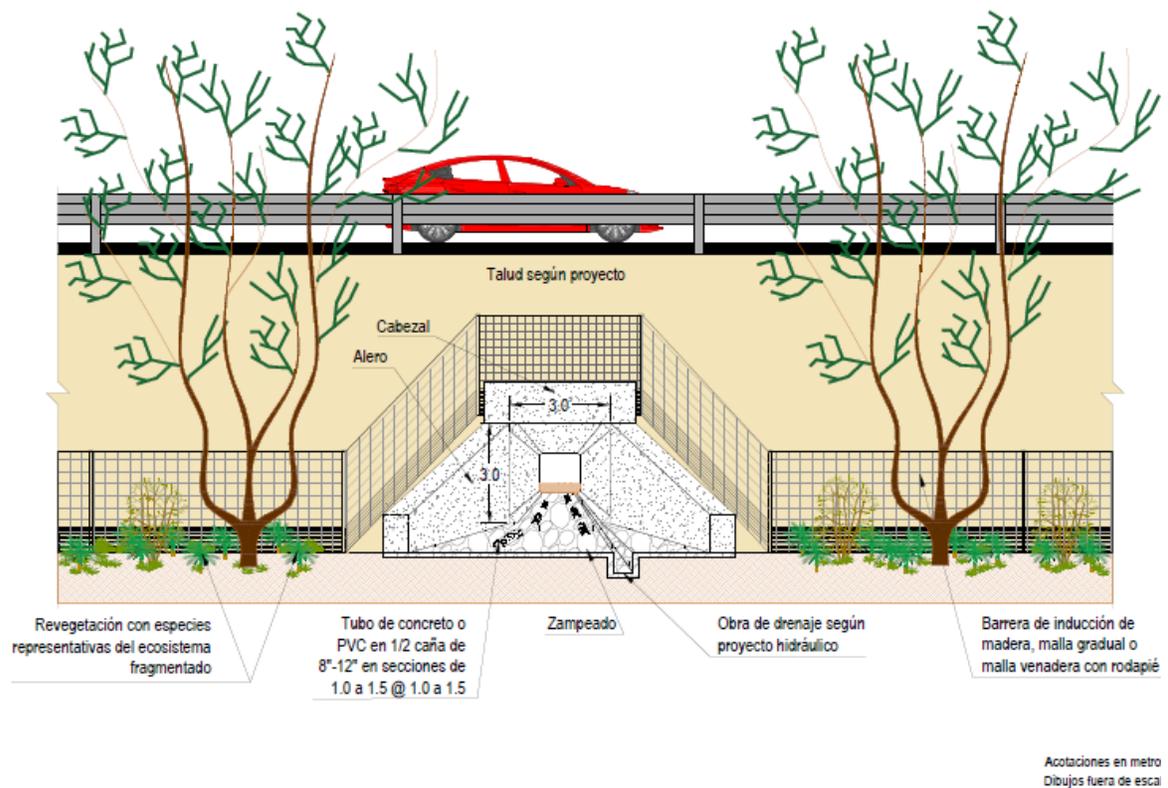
Alzado de un PSFA de 3 x 3 m con obra de drenaje
